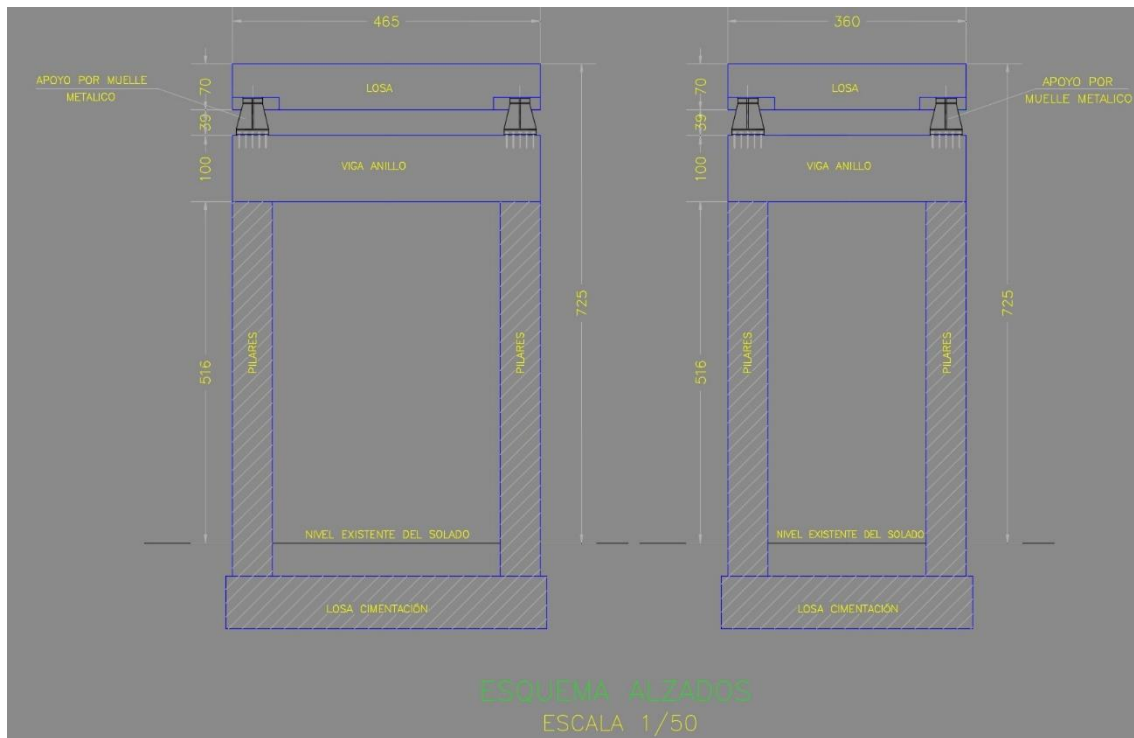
Plano AutoCAD de alzados de la nueva estructura. Losa de cimentación, pilares, viga anillo y losa.
